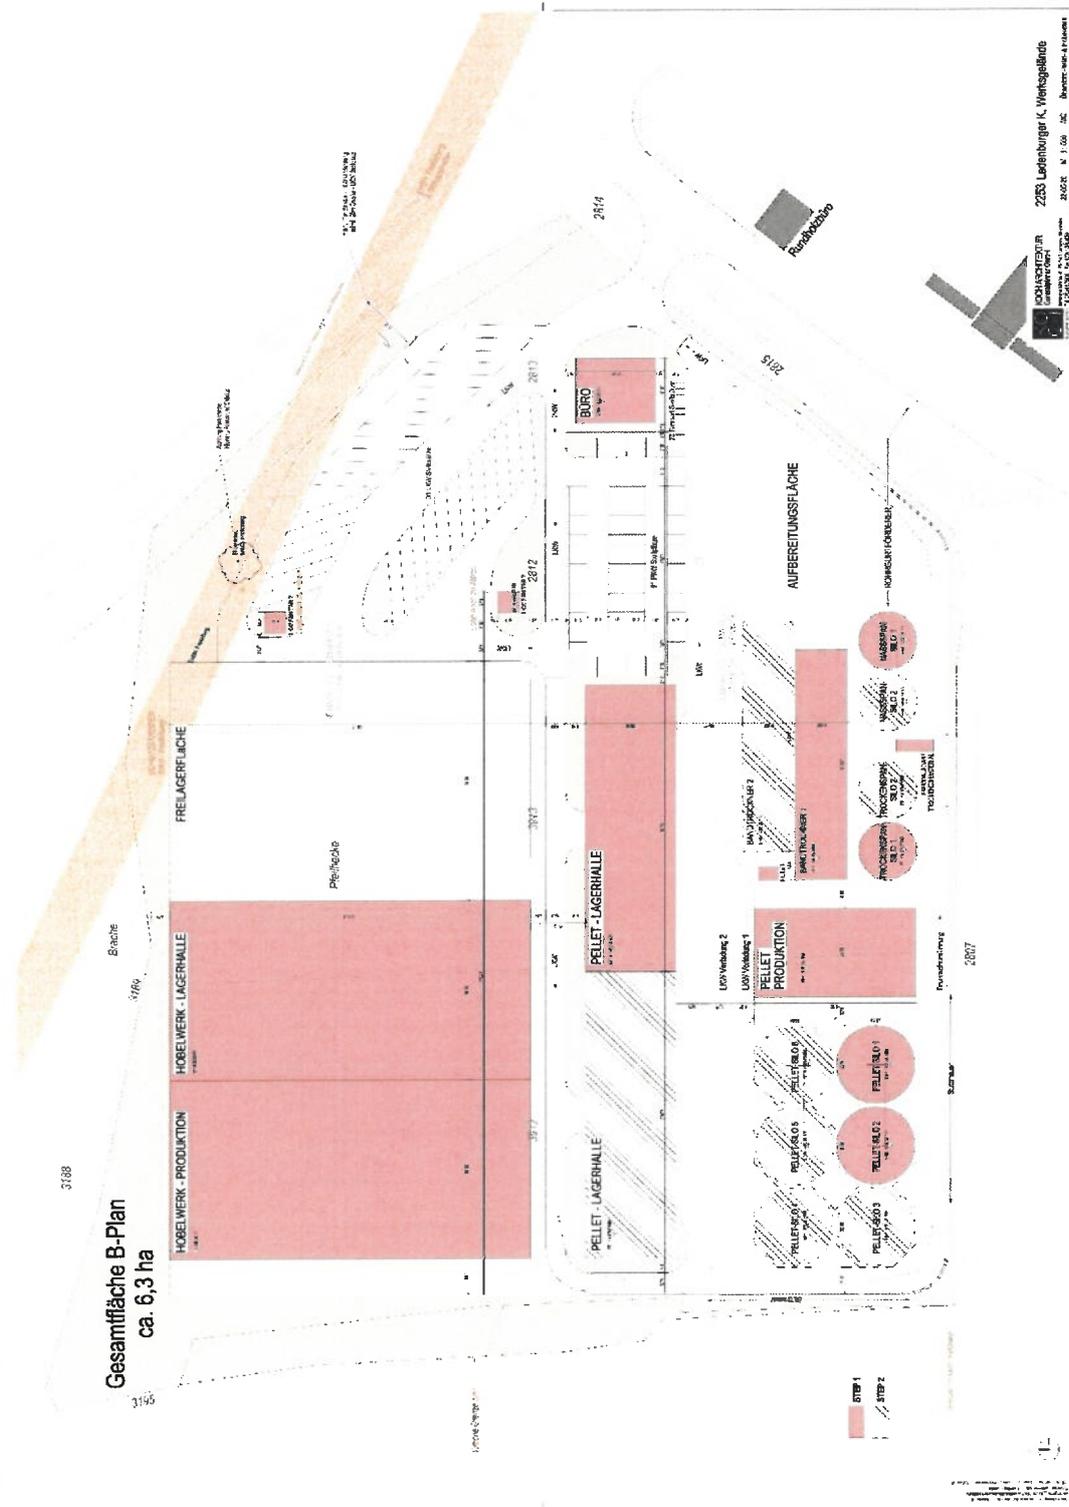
Lageplan der geplanten Betriebserweiterung der Ladenburger GmbH im Bebauungsplangebiet "Mooswiesen-West" [19].
